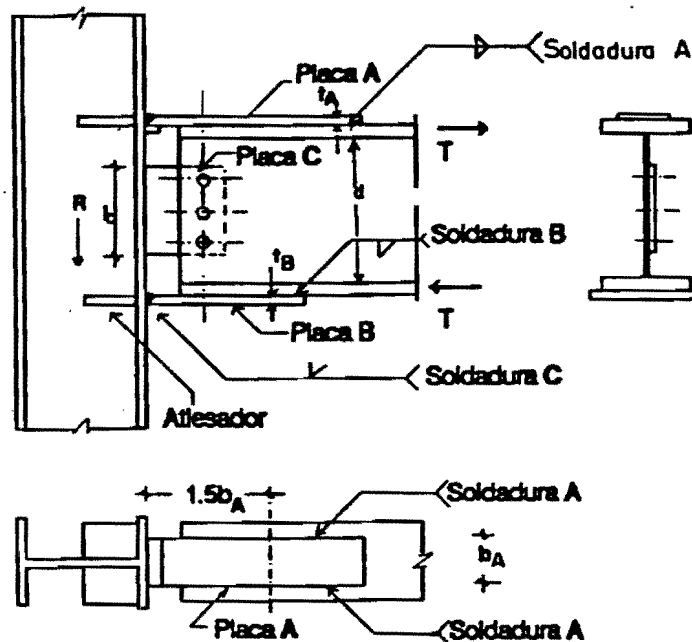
Conexión rígida con placas soldadas al patín y placa de cortante
